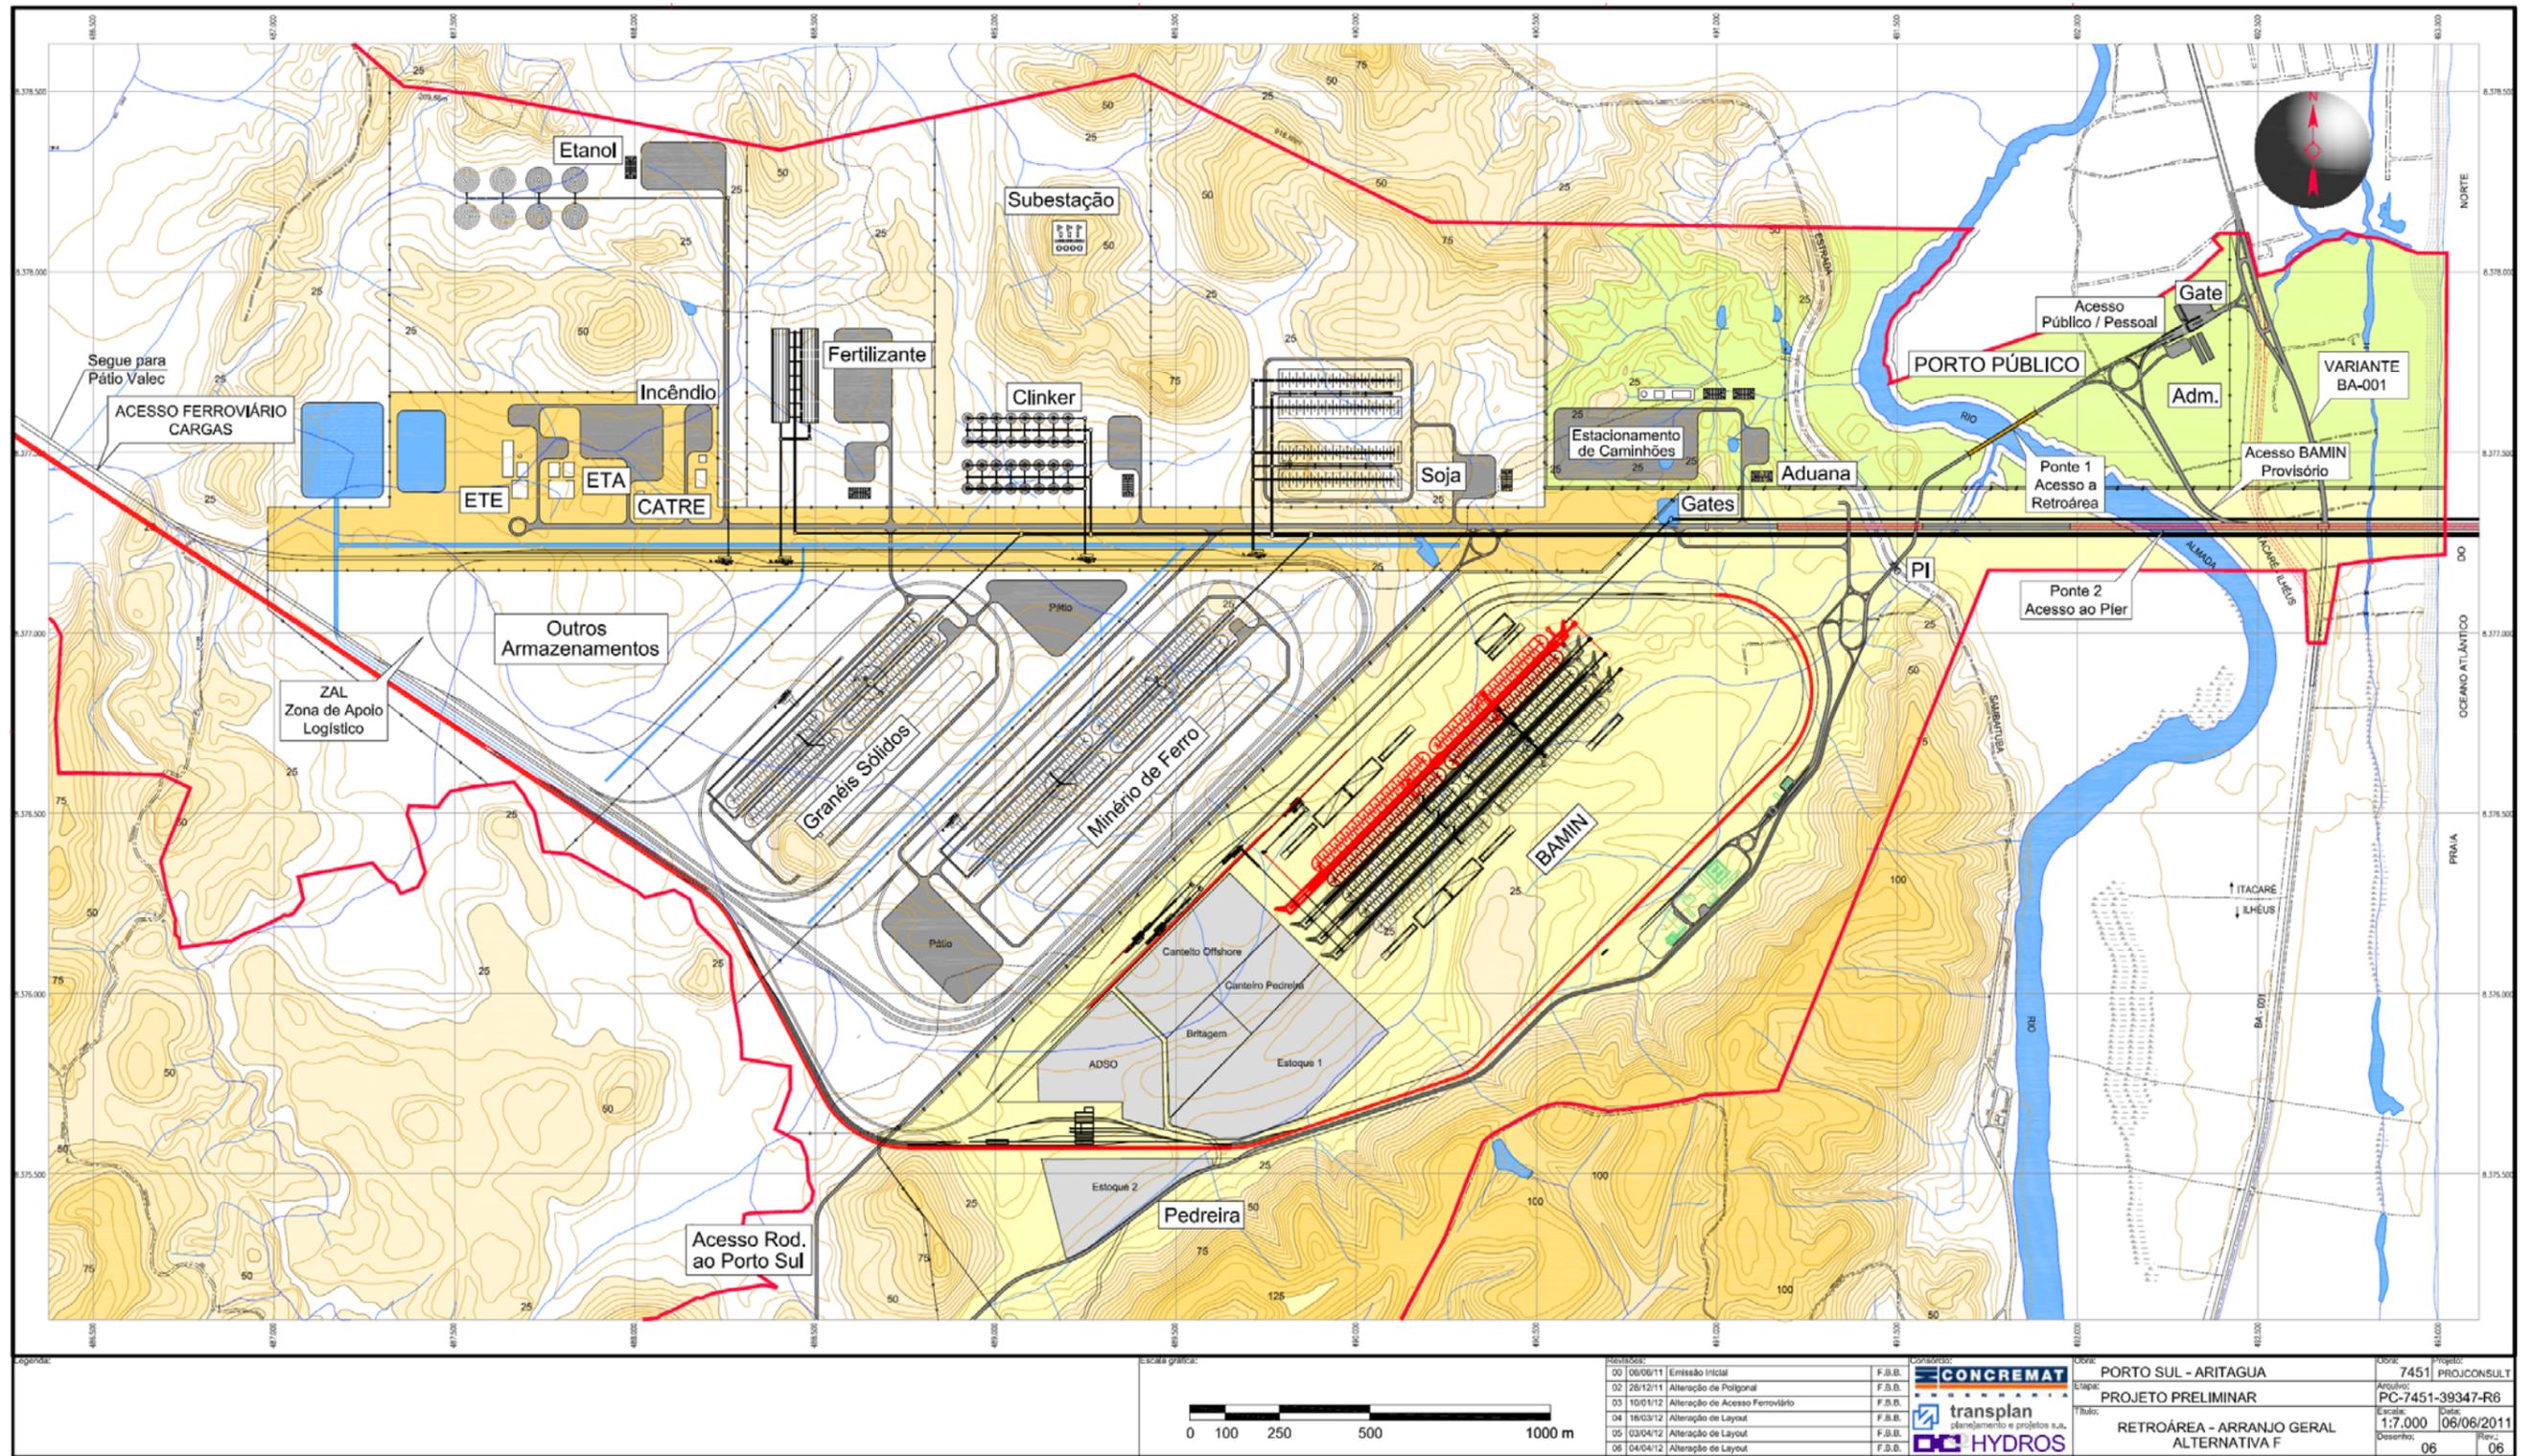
Planta Planialtimétrica Porto Sul - Estruturas Onshore
